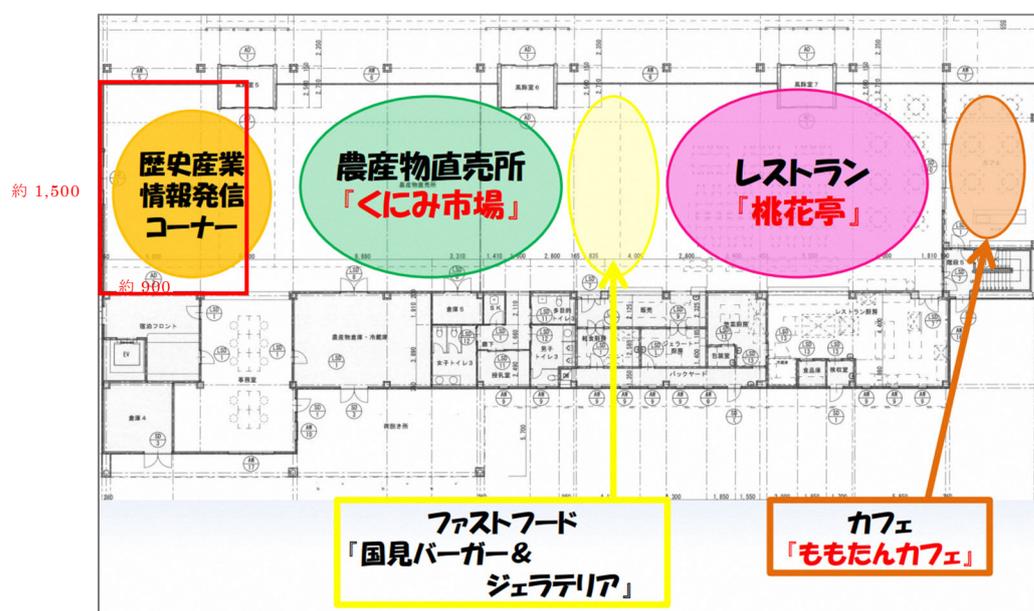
道の駅「国見 あかつしの郷」北棟 1 階 平面図
